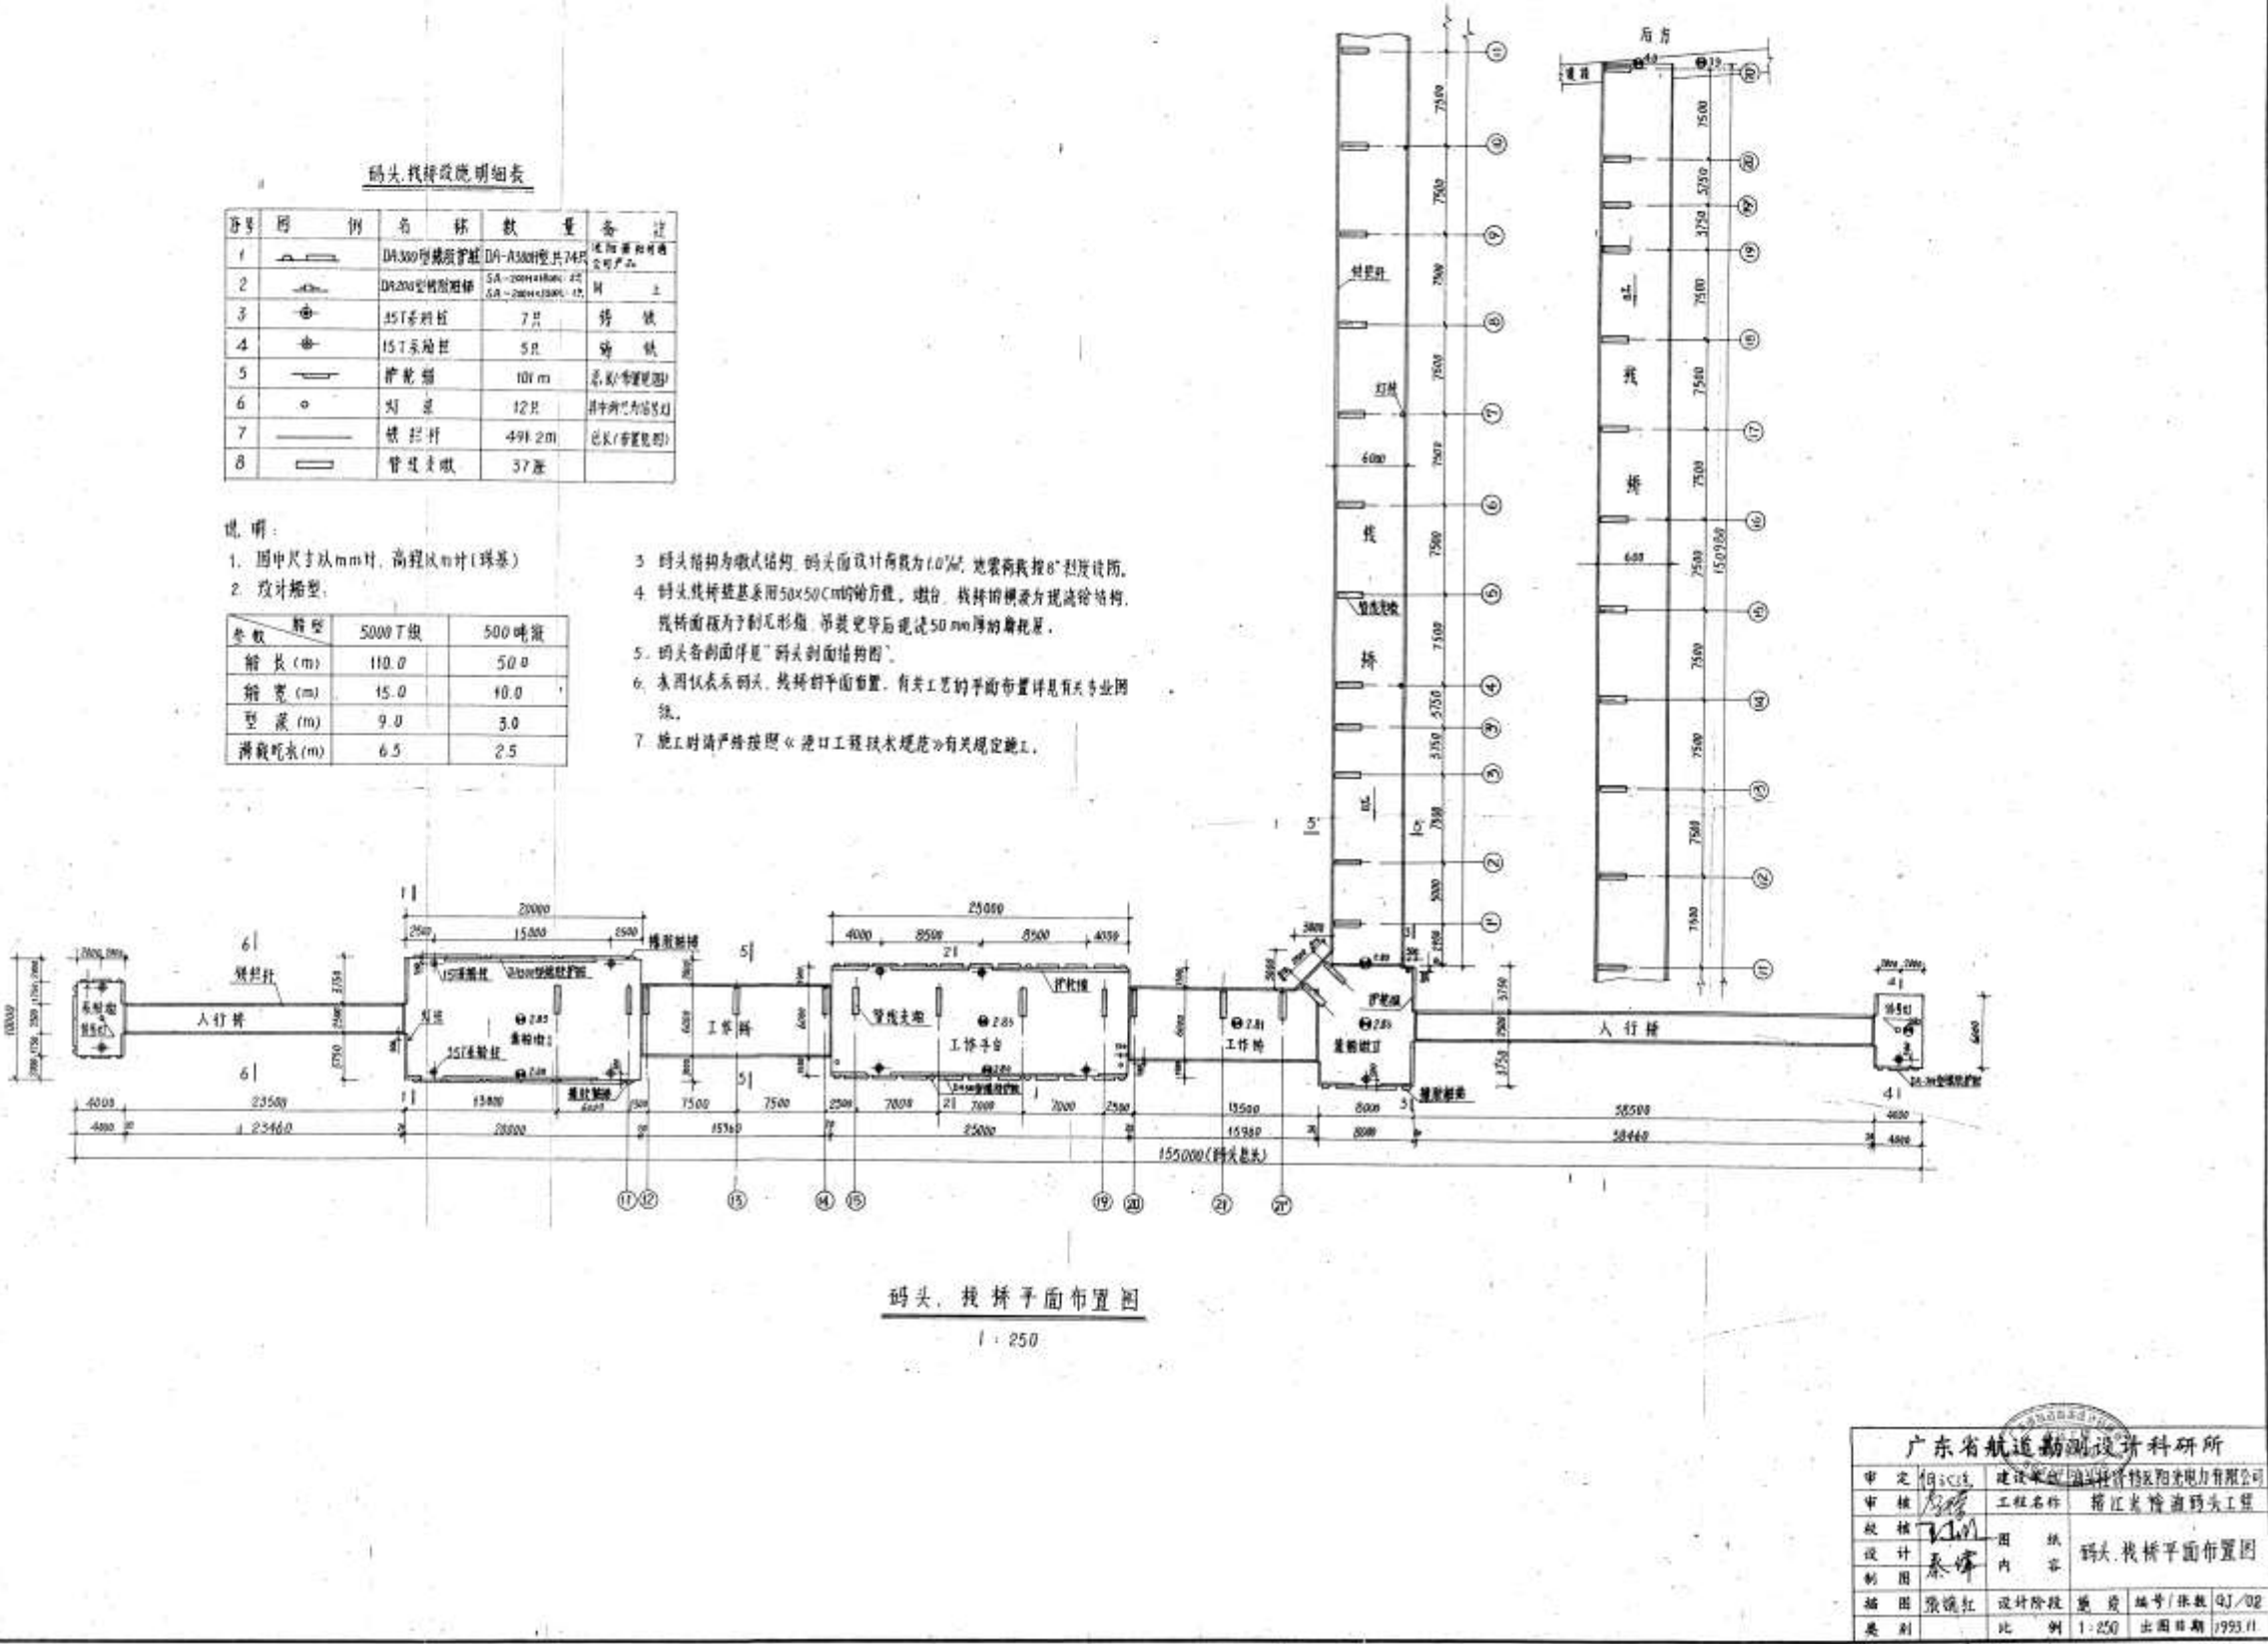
码头、引桥平面布置图（1993 年）
